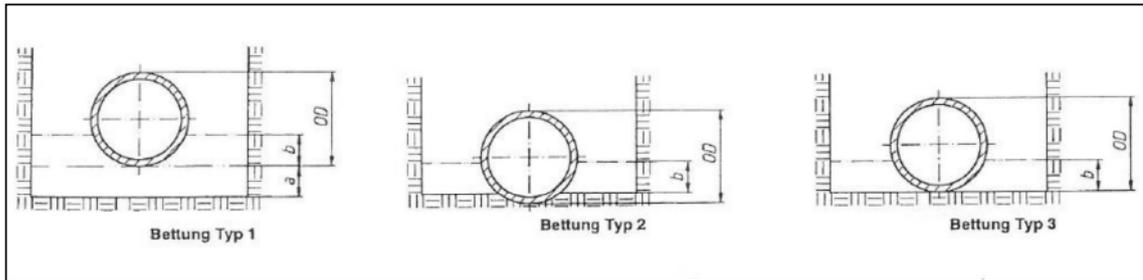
Rohrbettungstypen nach DIN EN 1610
